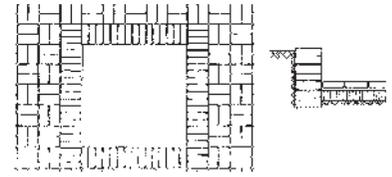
Artesa para plantas con muro sobresaliendo del pavimento. Se recomienda prever en los interiores de la artesa una barrera contra humedades, con el fin de evitar la aparición de eflorescencias hacia el exterior.
